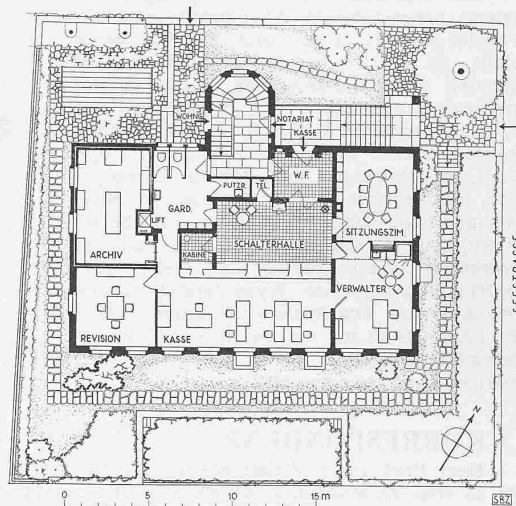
Lageplan mit Erdgeschoss-Grundriss, 1:400
